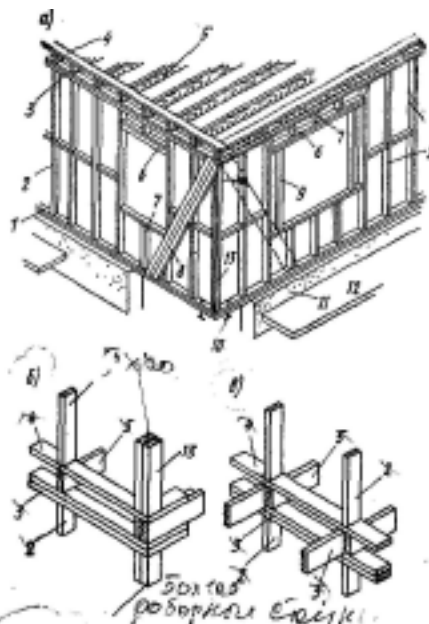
Конструкции каркасного дома с платформенным сопряжением стоек:
